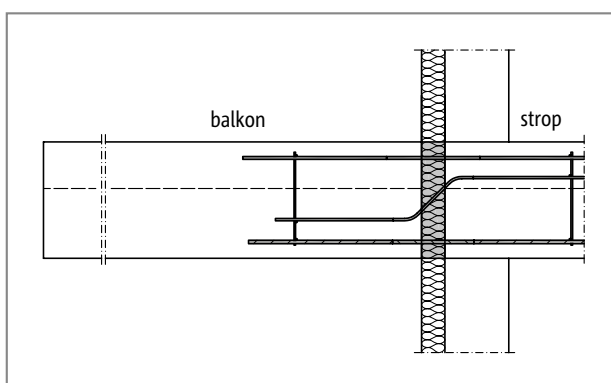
Schöck Isokorb® tip S: konstrukcija balkona z nepodprtimi spodnjimi vezmi (balkon iz montažnih elementov)
